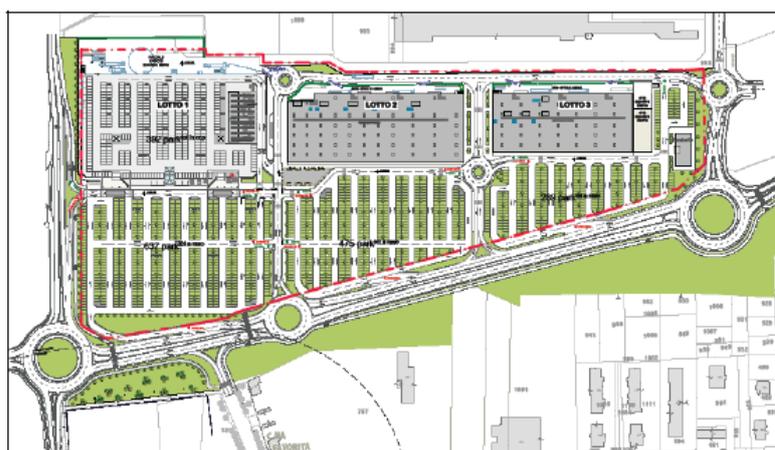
\_ Planimetria d'insieme (Relazione Generale allegata al P.E.C.)
